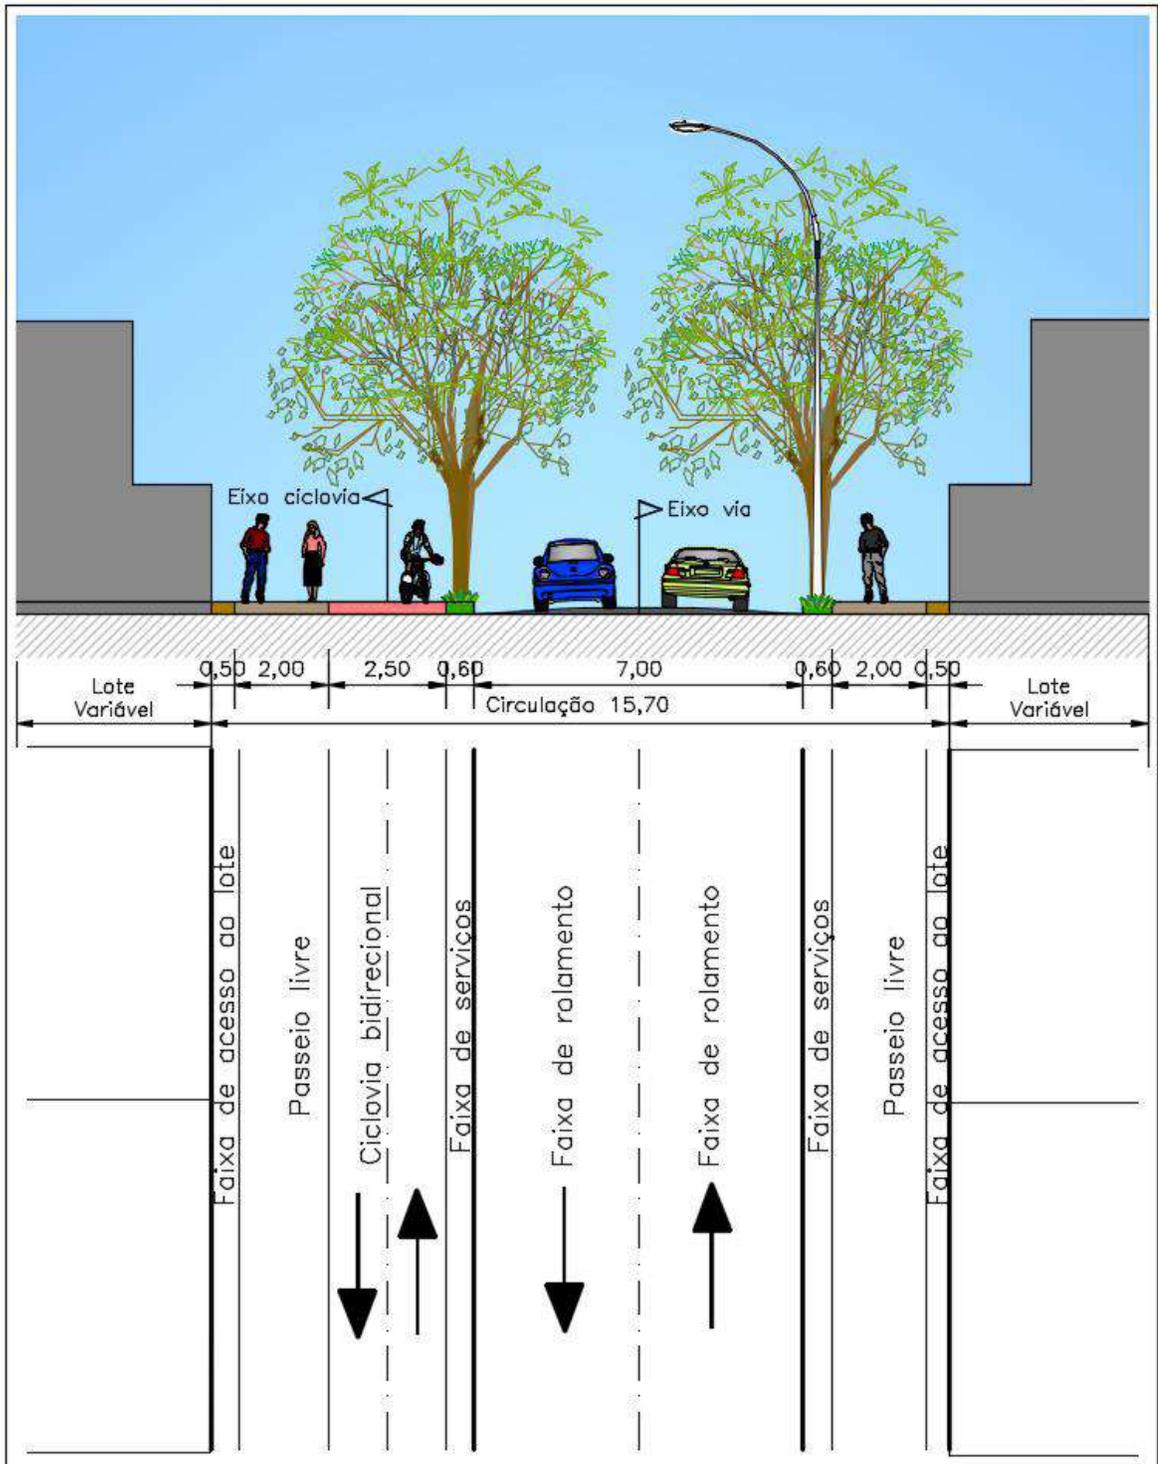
Perfil 1 – Via de Circulação de Vizinhança – tipo 1
